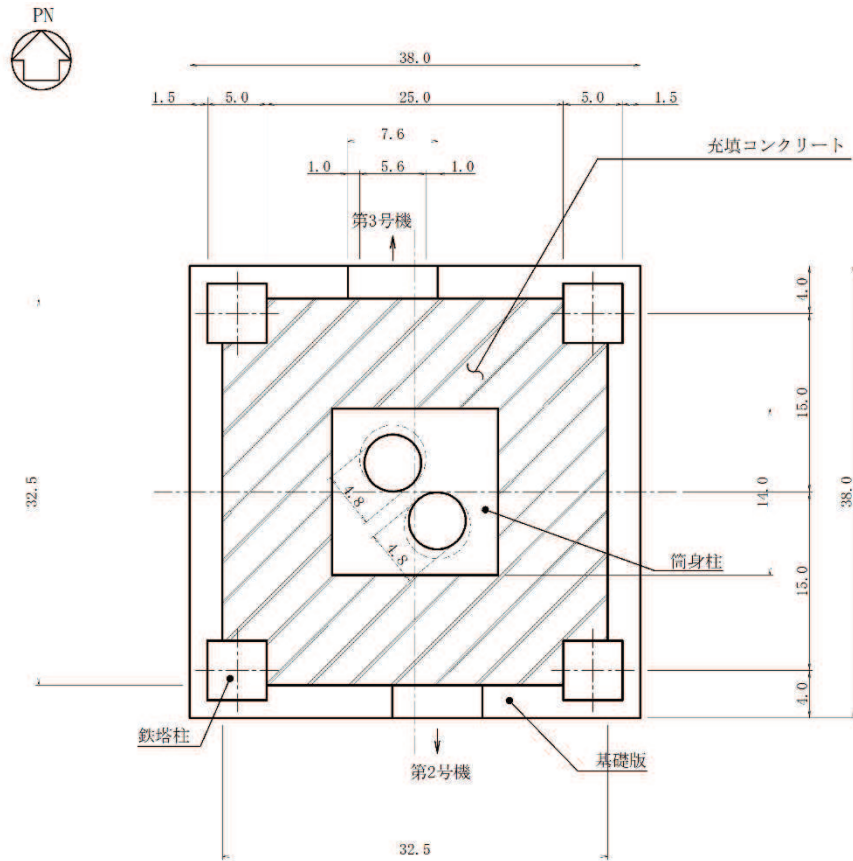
排気筒基礎平面図 (O.P. 8.505m)
